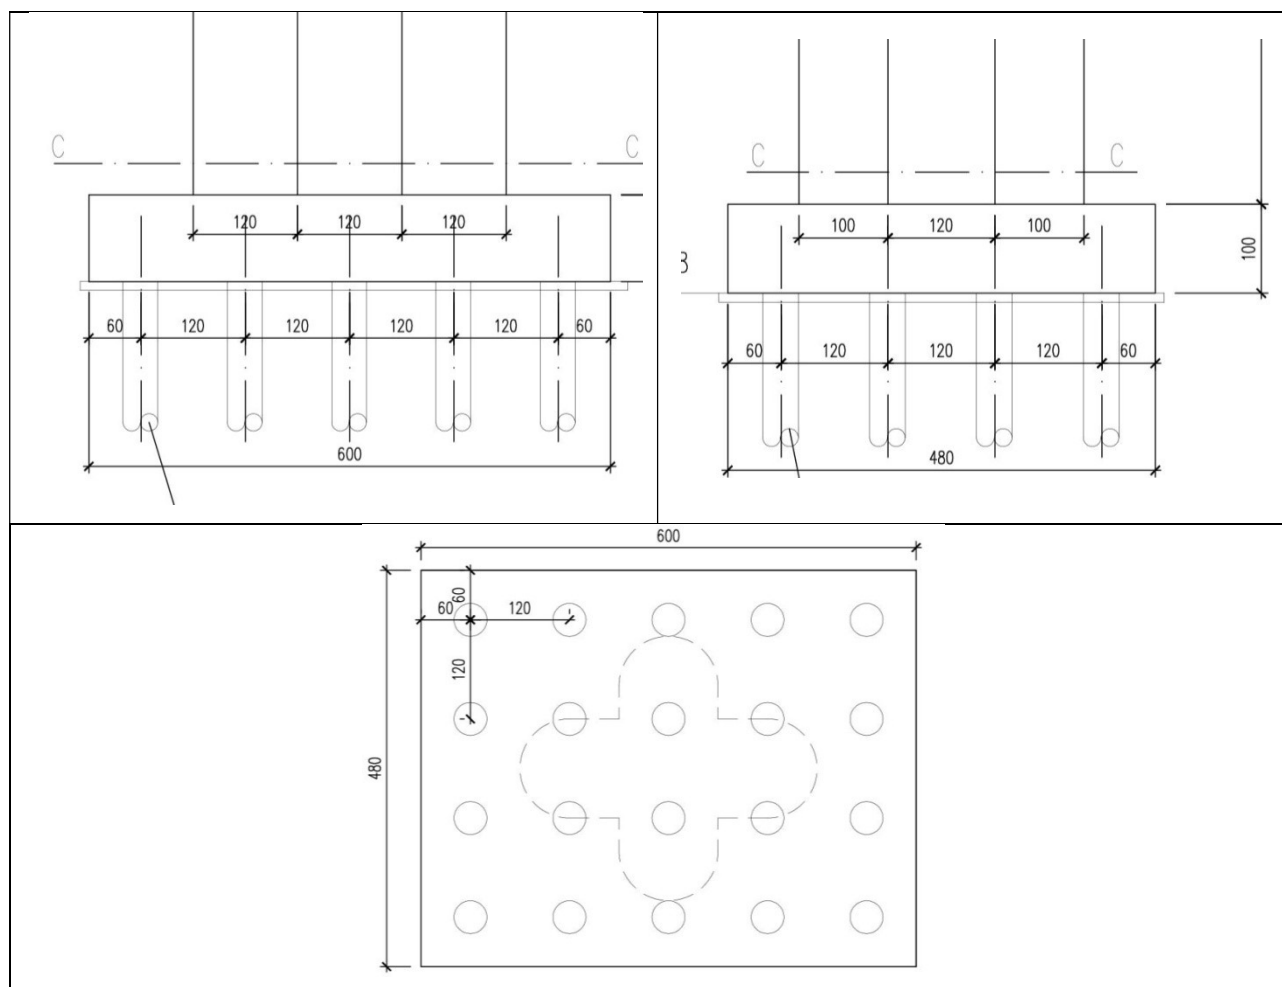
Plinto pila 1: vista frontale, vista laterale e pianta
